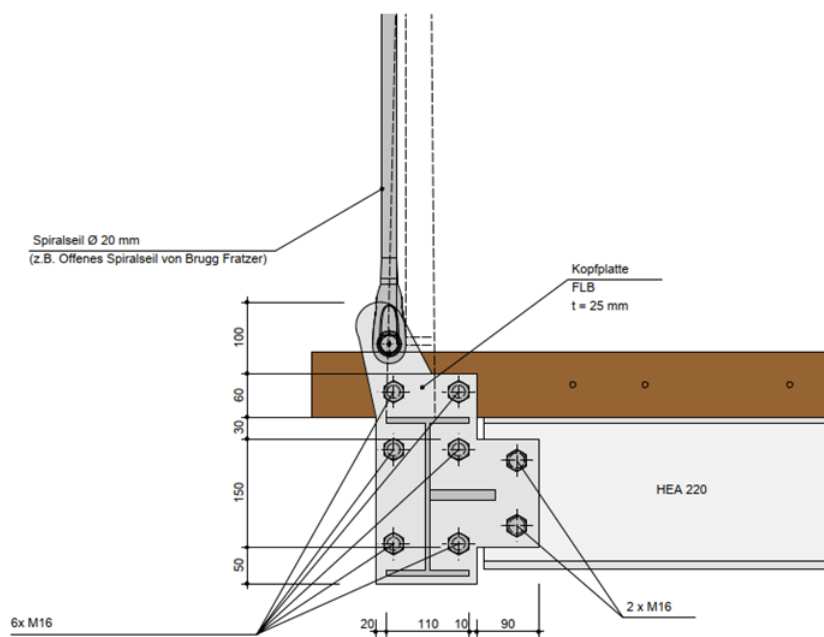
Detail Seilverankerung Fussgängersteg Wattwil
